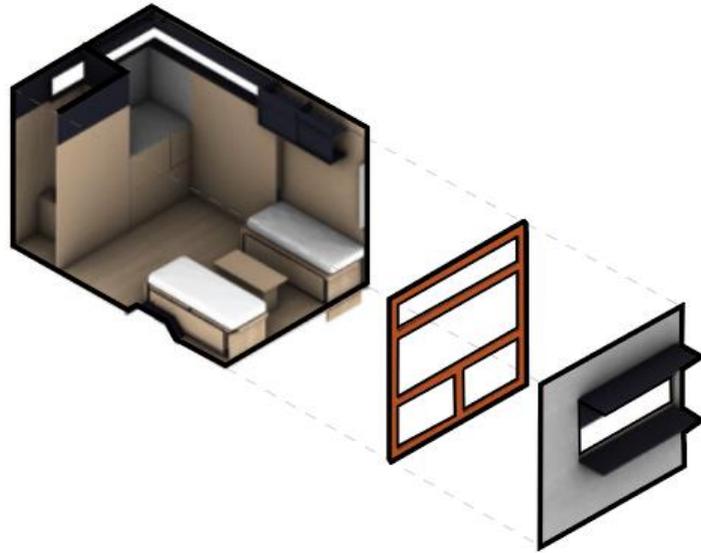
Axonometría - Detalle de Sistema constructivo
